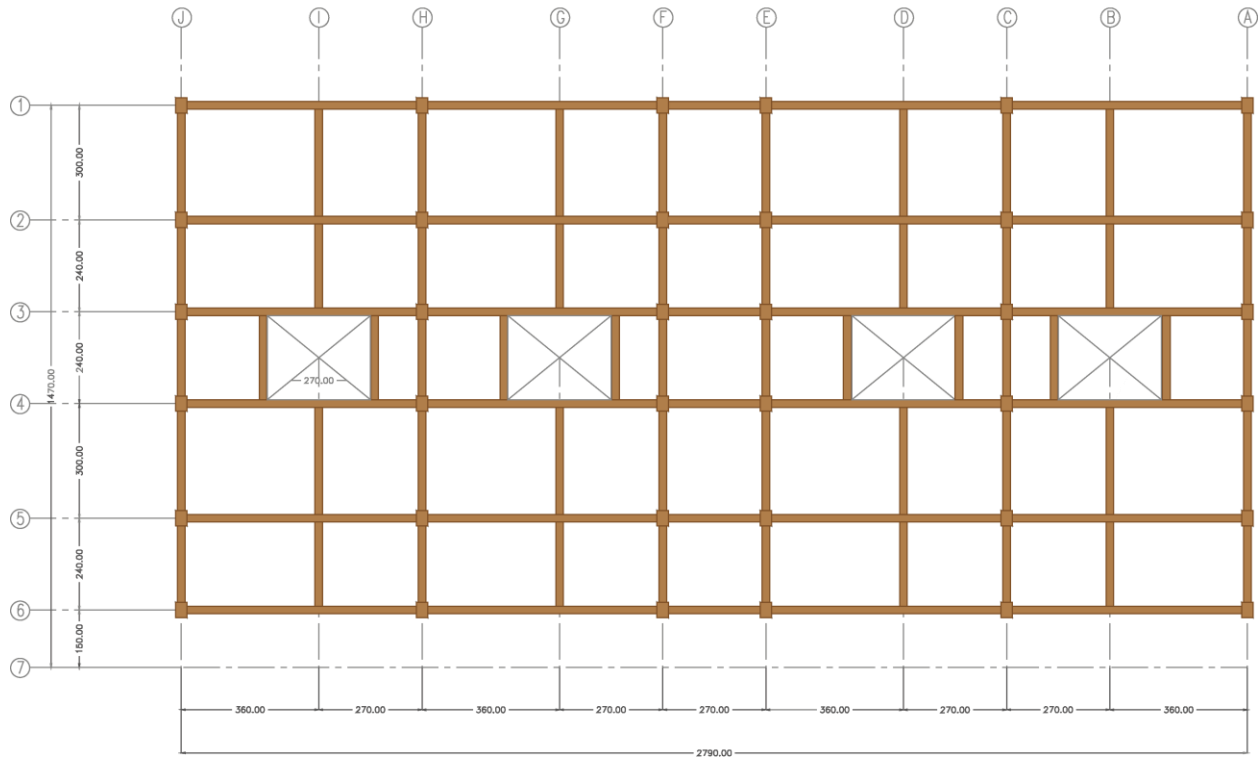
Plano estructural desde nivel 2 al 5 en madera laminada. Elaboración Propia.
